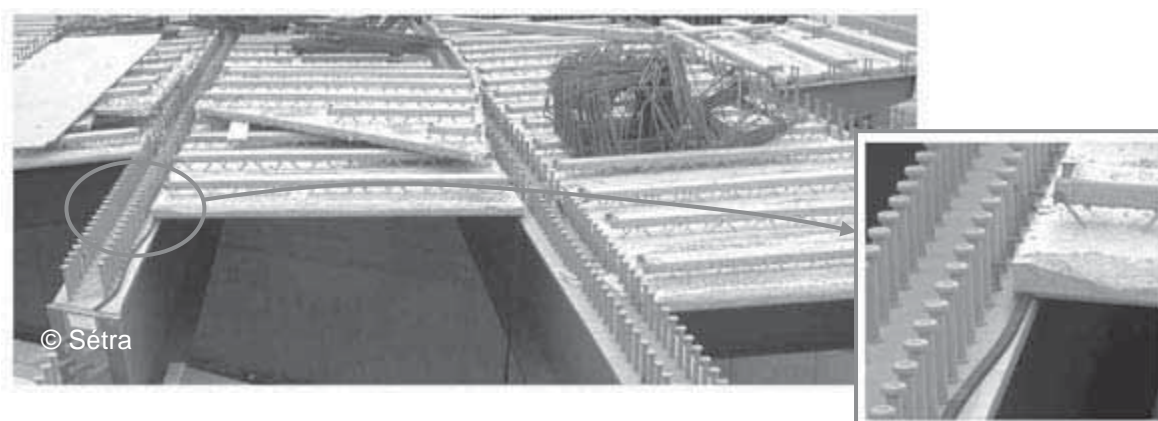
Utilisation d'une prédalle comme coffrage
